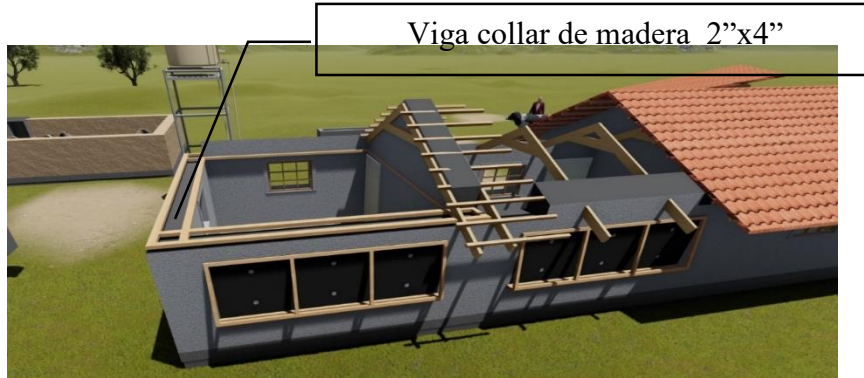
Arriostre horizontal en muro con viga collar en vivienda rural
